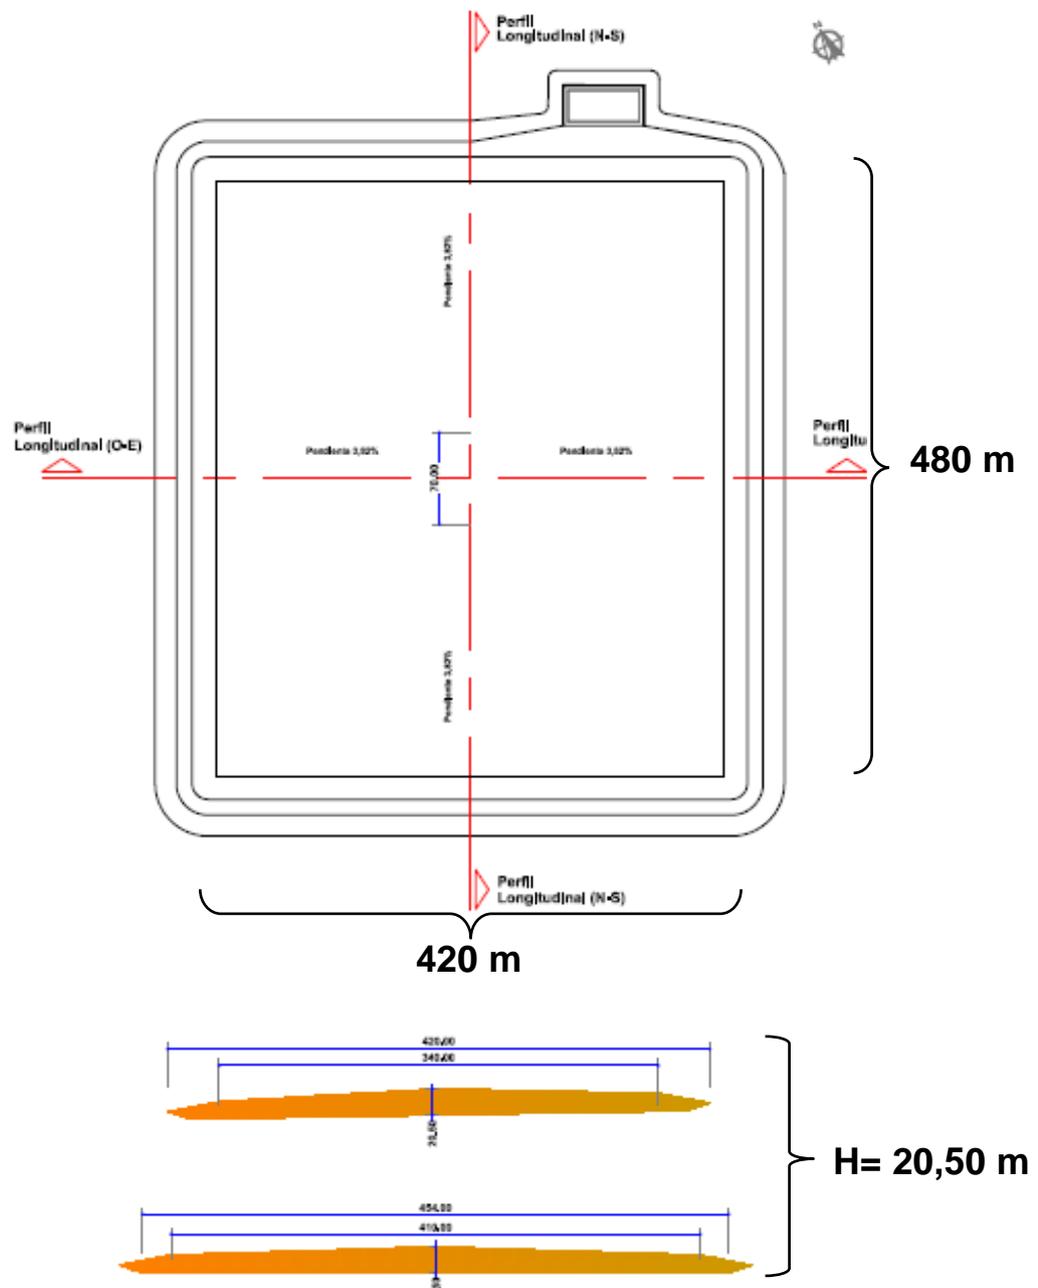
Croquis Planta de Módulo de disposición final y Cortes Esquemáticos
